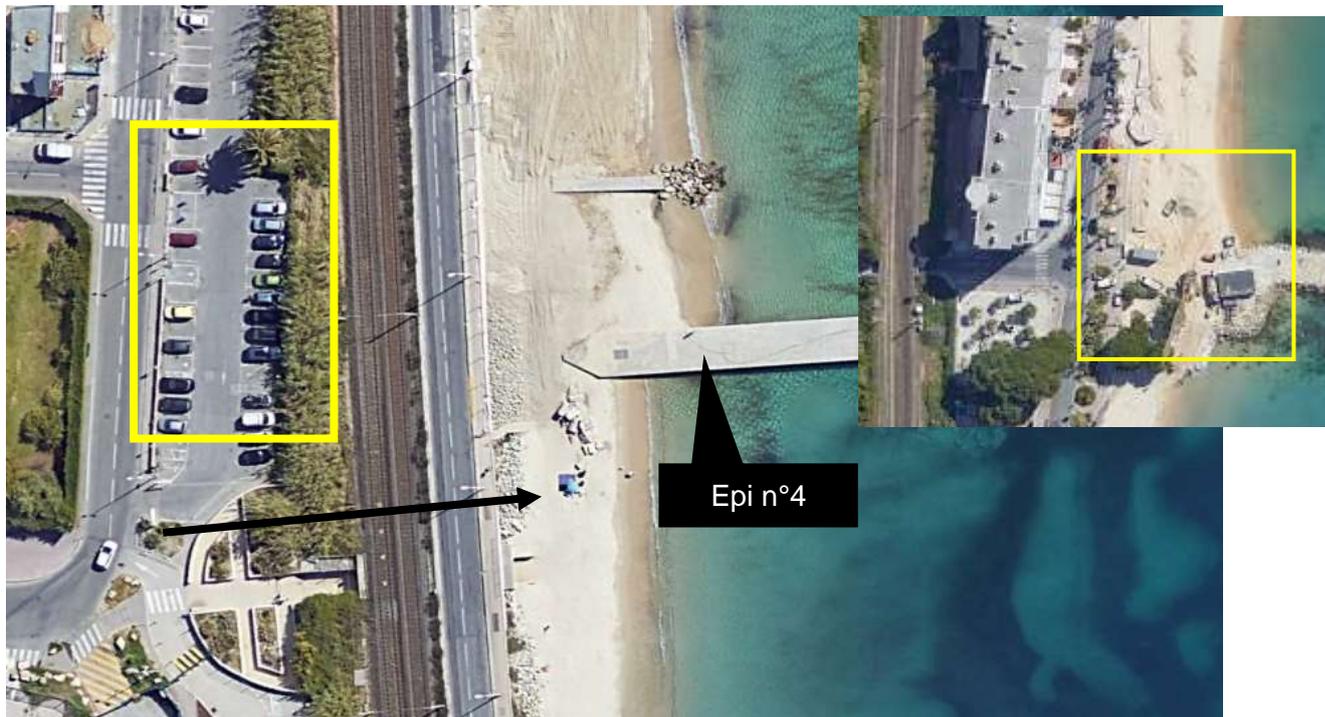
Installation possible du chantier avec voie d'accès sur la plage lors des travaux sur l'épi n°4 et parking des engins aux abords de l'épi n°5 (image droite) – GoogleEarth
